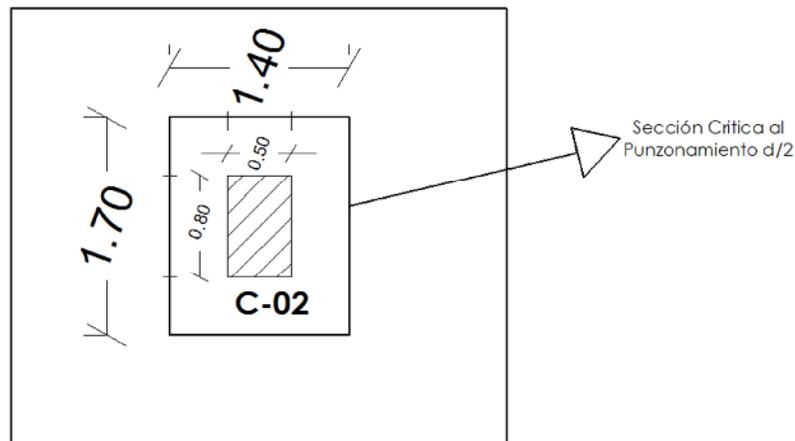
Sección crítica al Punzonamiento de la Columna C-02.
